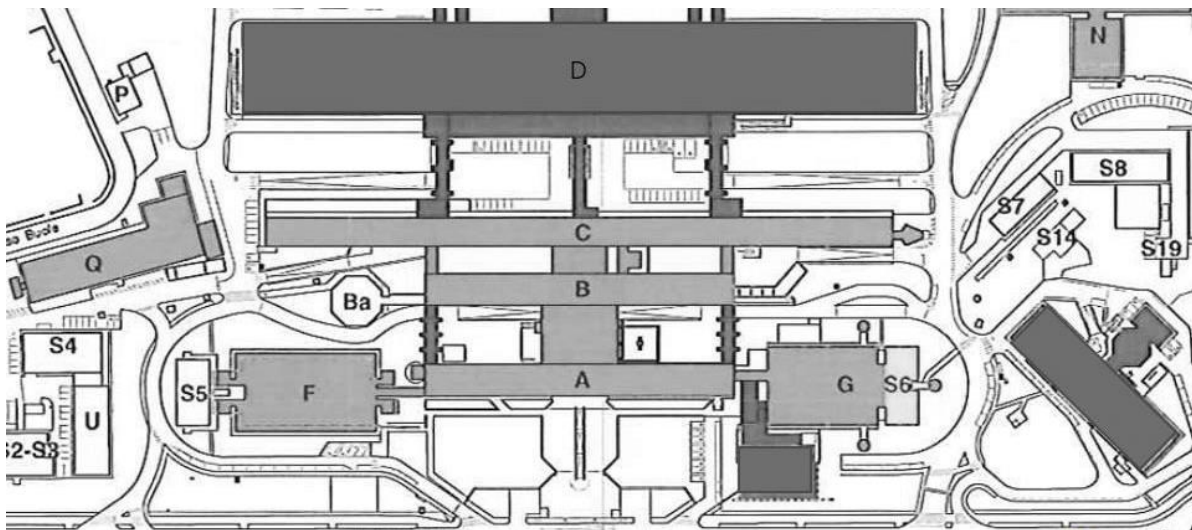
Planimetria di inquadramento Arcispedale Santa Maria Nuova.
